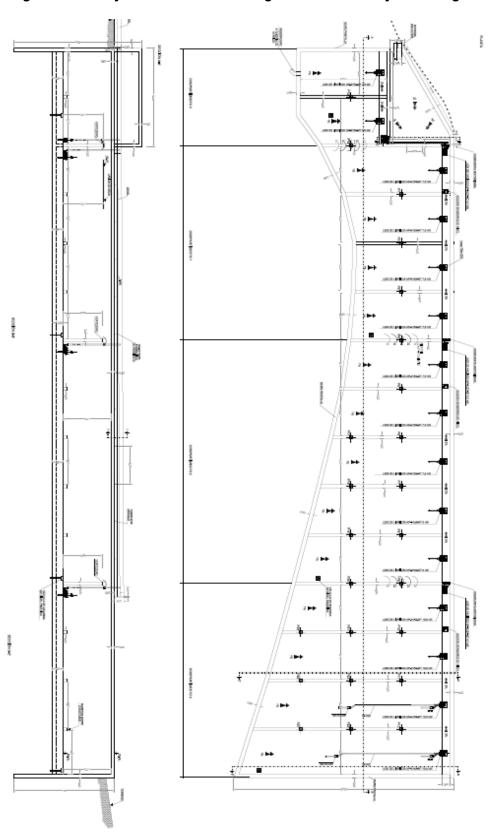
Planta y sección del TQT de Alguazas con muros y muretes guía
